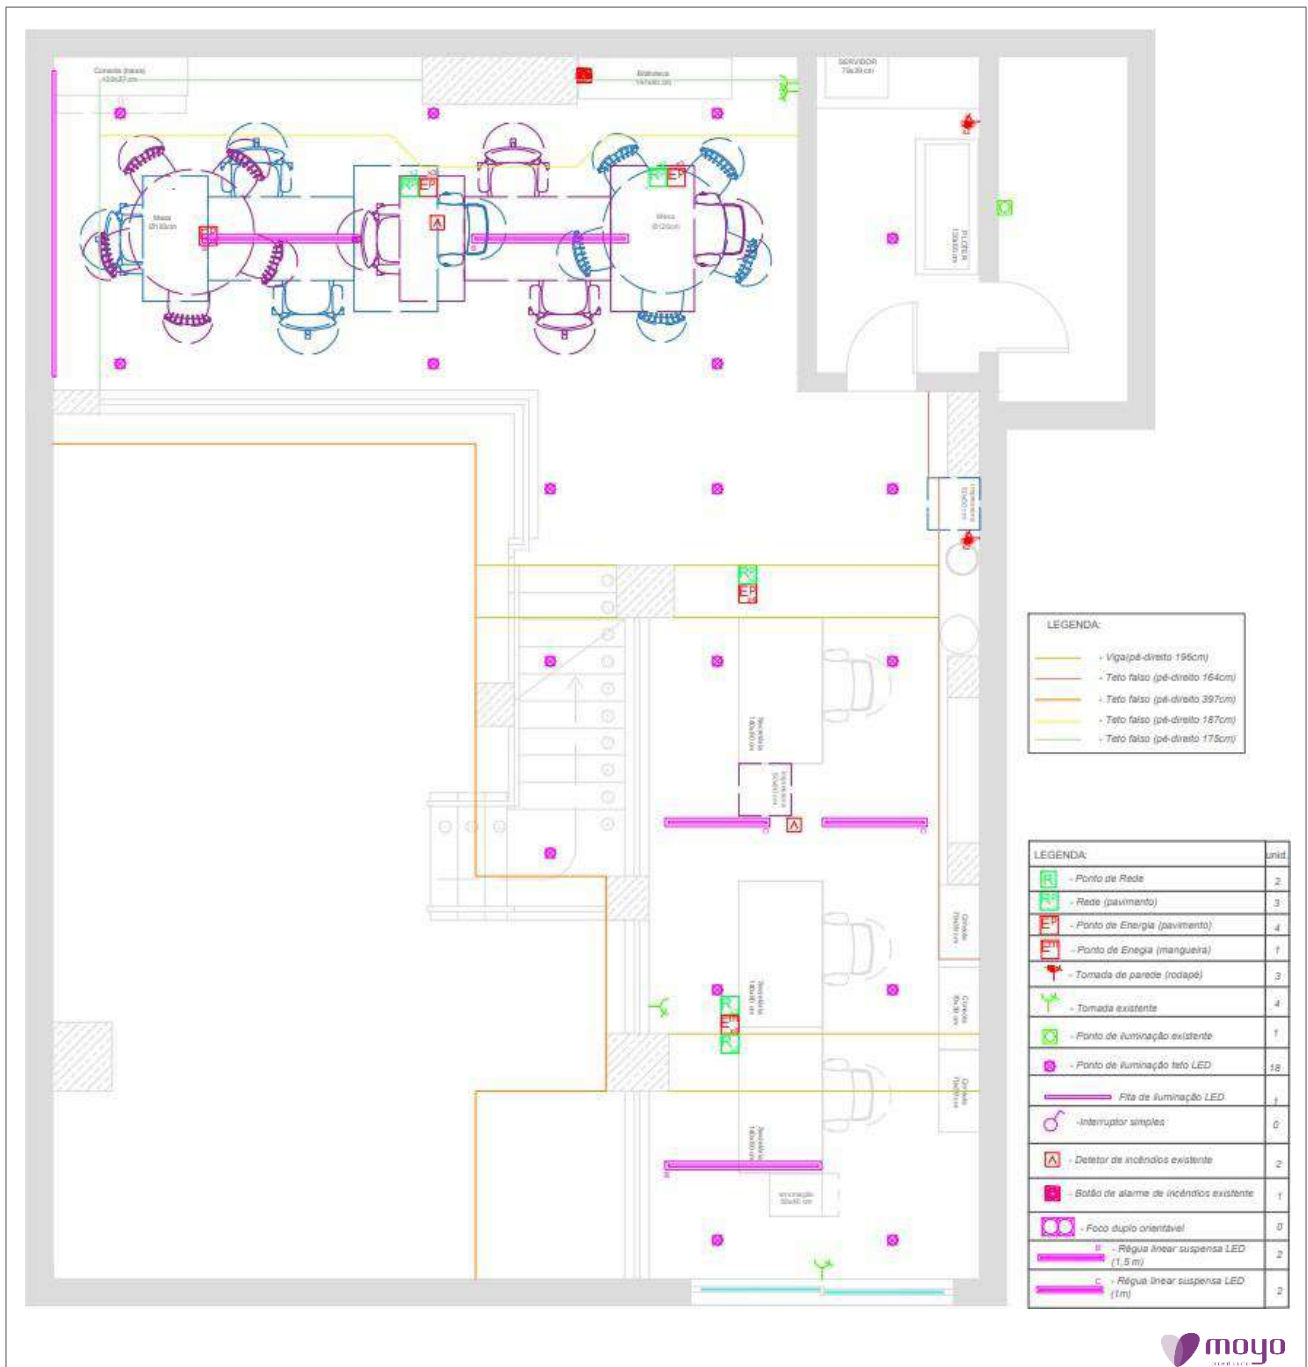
Planta elétrica e de Iluminação Loja Moyo (Piso 1)- OPÇÃO A
